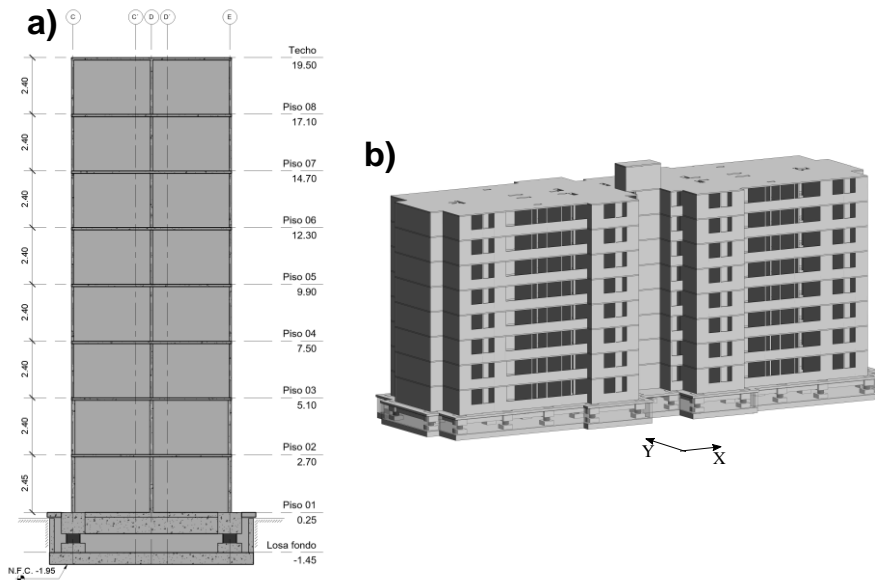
a) Elevación y niveles de piso; b) vista en 3D del edificio aislado sísmicamente y parte de su sistema de aislamiento.
